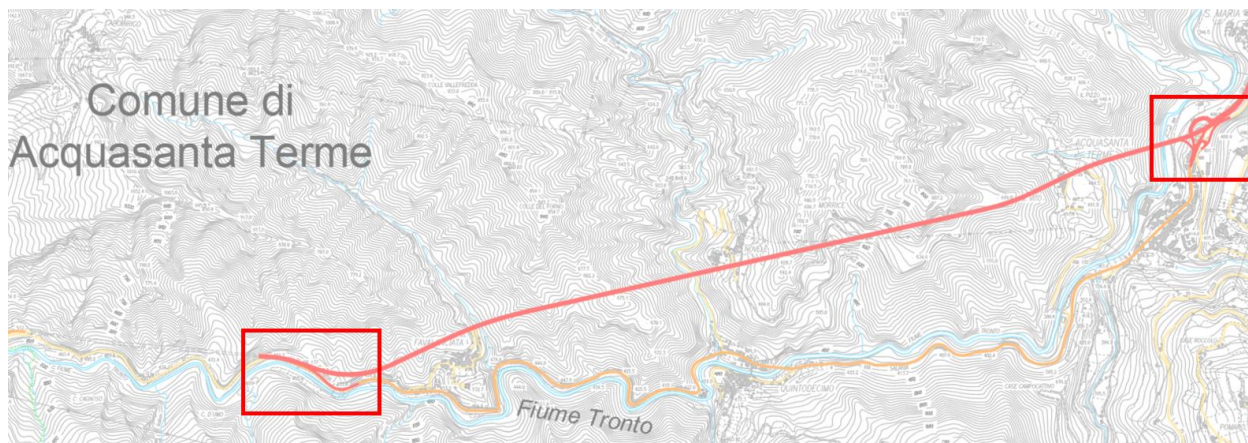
Inquadramento planimetrico delle opere secondarie.
